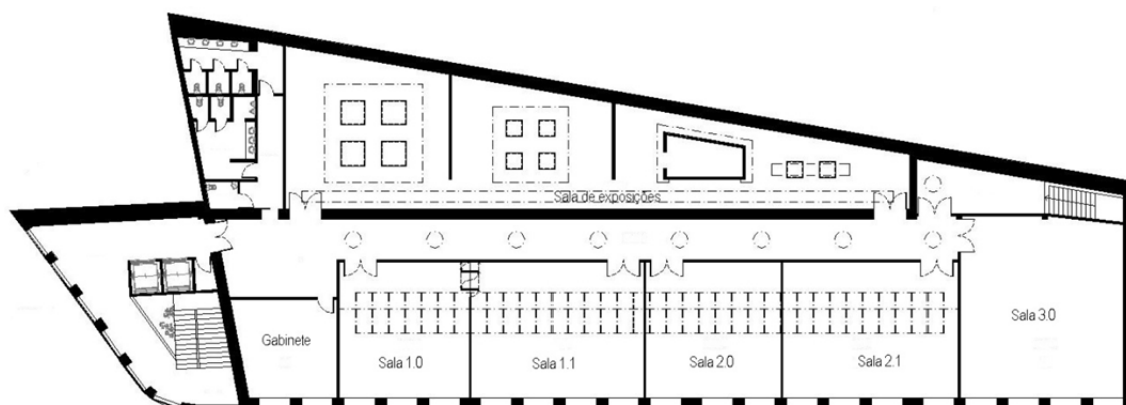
Planta do Projecto de Reabilitação, Piso 2
